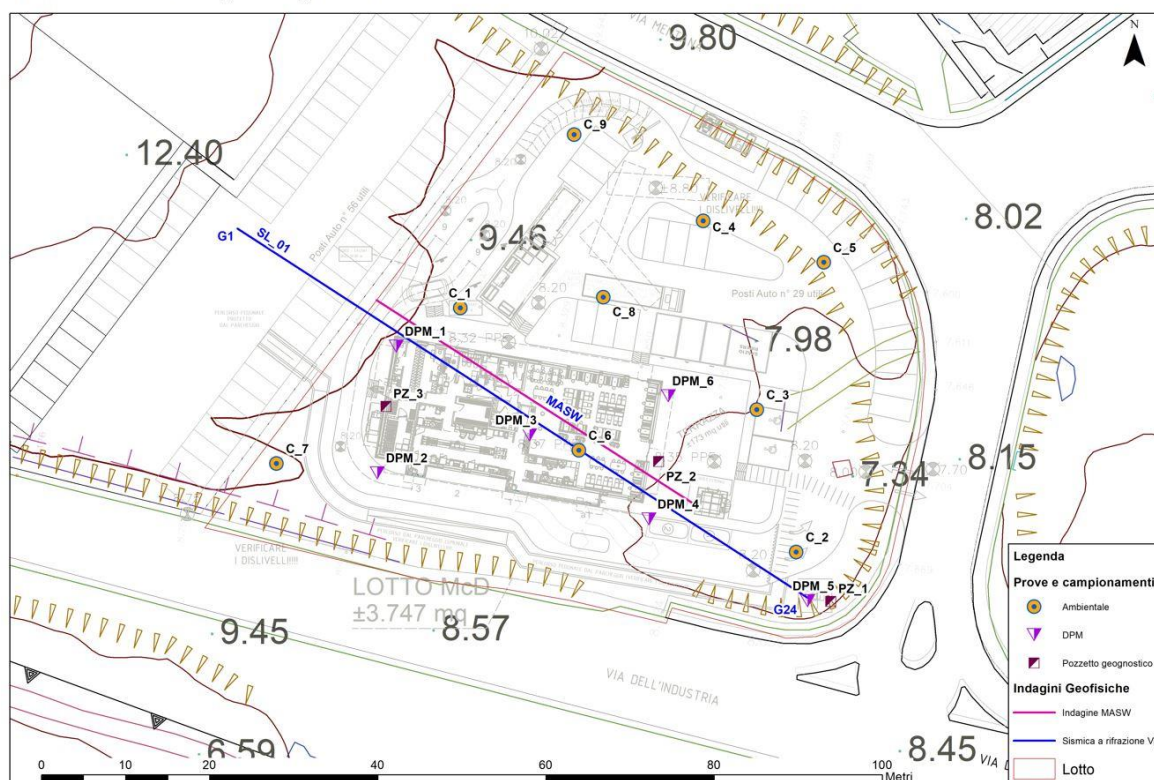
Stralcio della Planimetria delle indagini geognostiche
